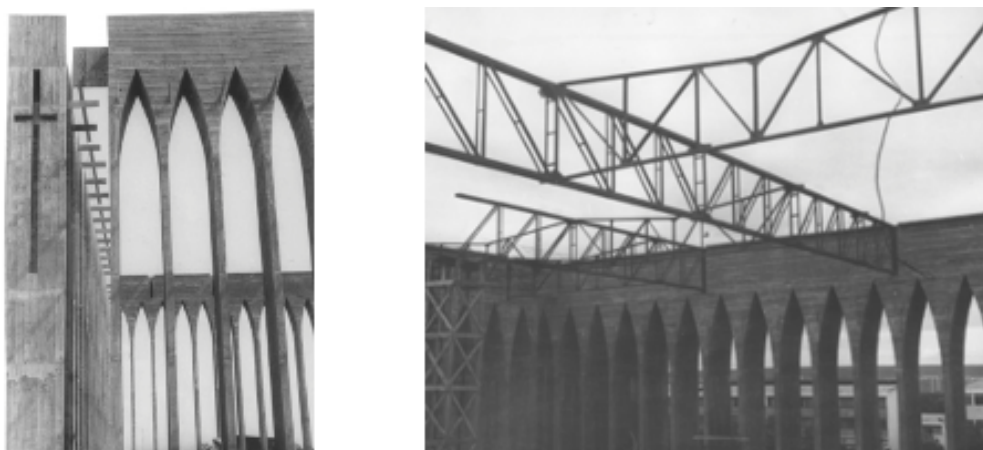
Detalhes da construção do Pilares e instalação das treliças do telhado.
